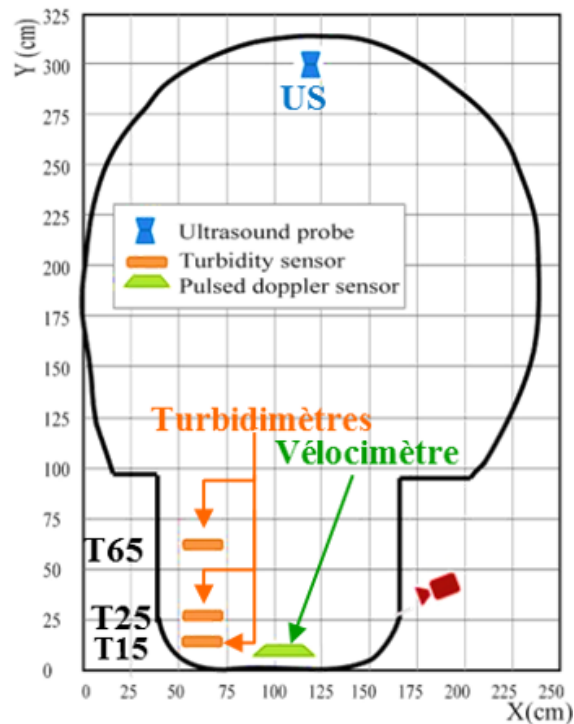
Installation des appareils de mesures hydro-sédimentaires sur la coupe transversale.
